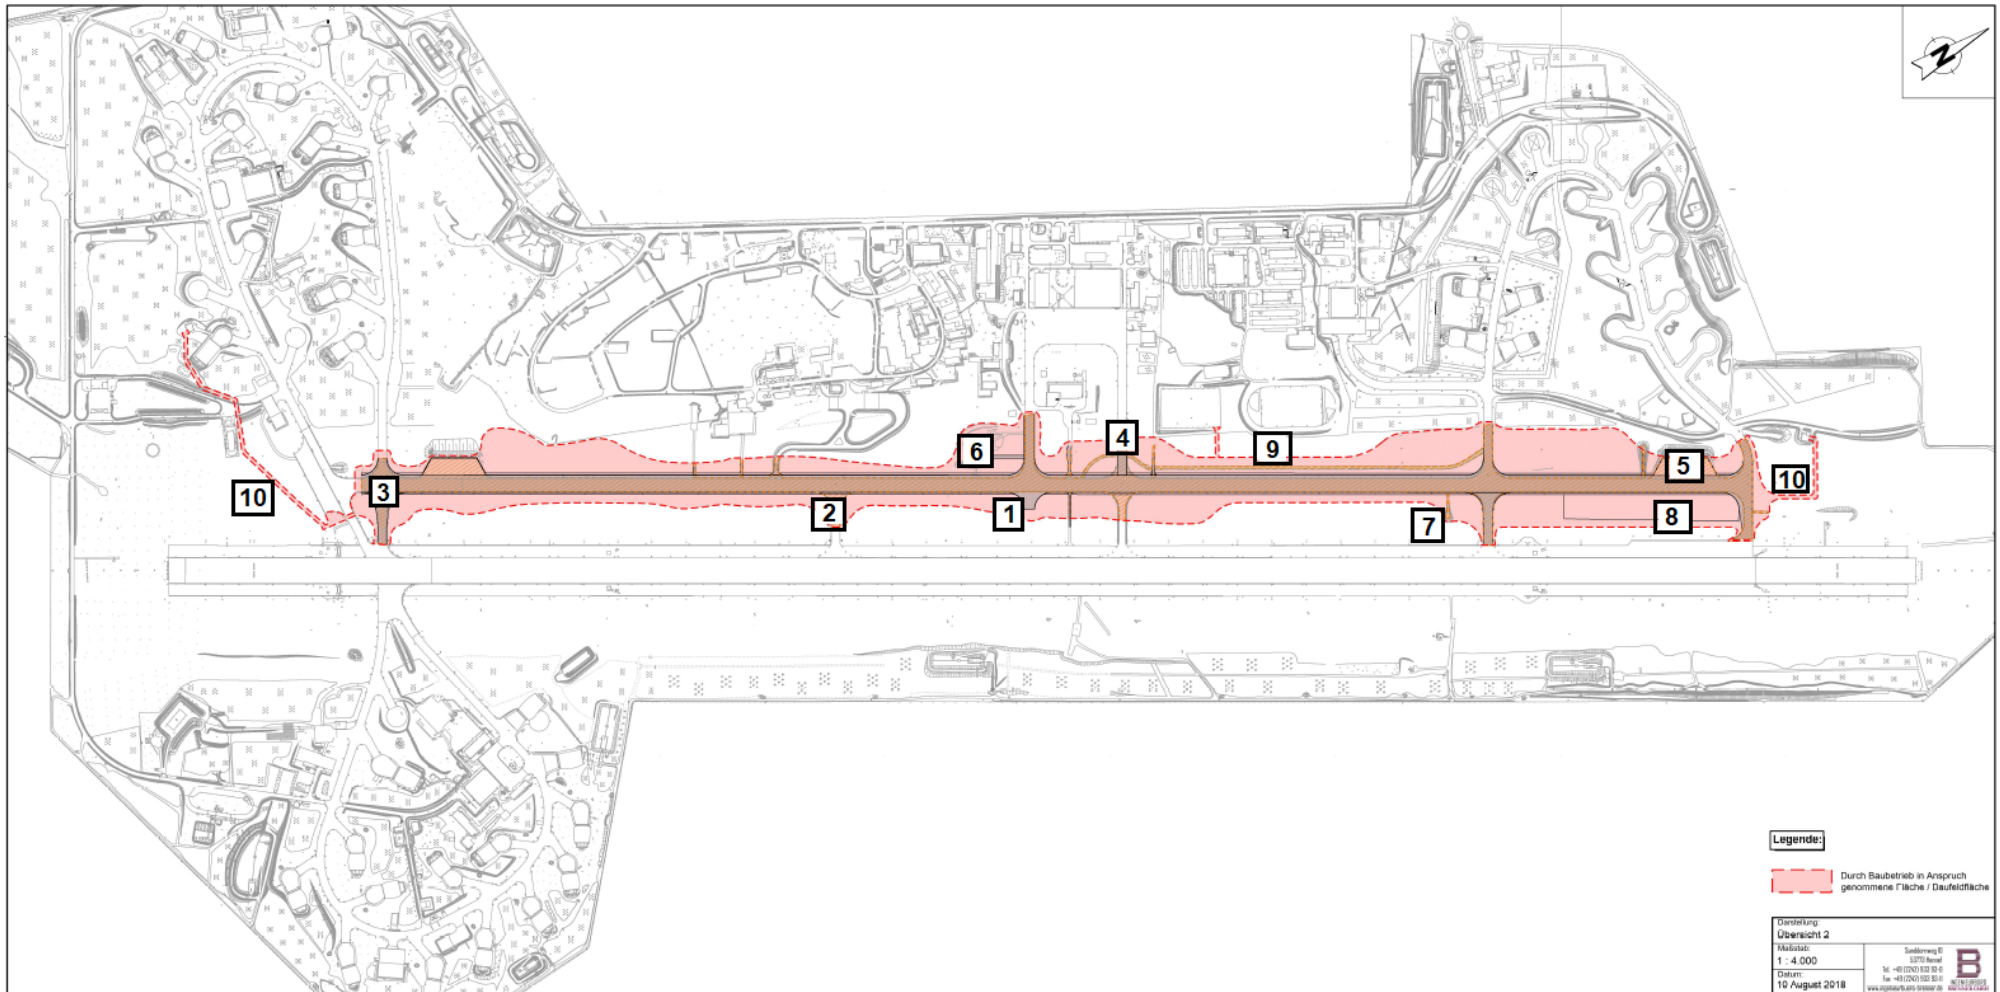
Übersichtslageplan mit Einzelmaßnahmen Ziff. 1 - 10 und Baufeld (Eingriffsfläche) im Rahmen „Sanierung Taxiway und Intersections“ NATO-Flugplatz Büchel
